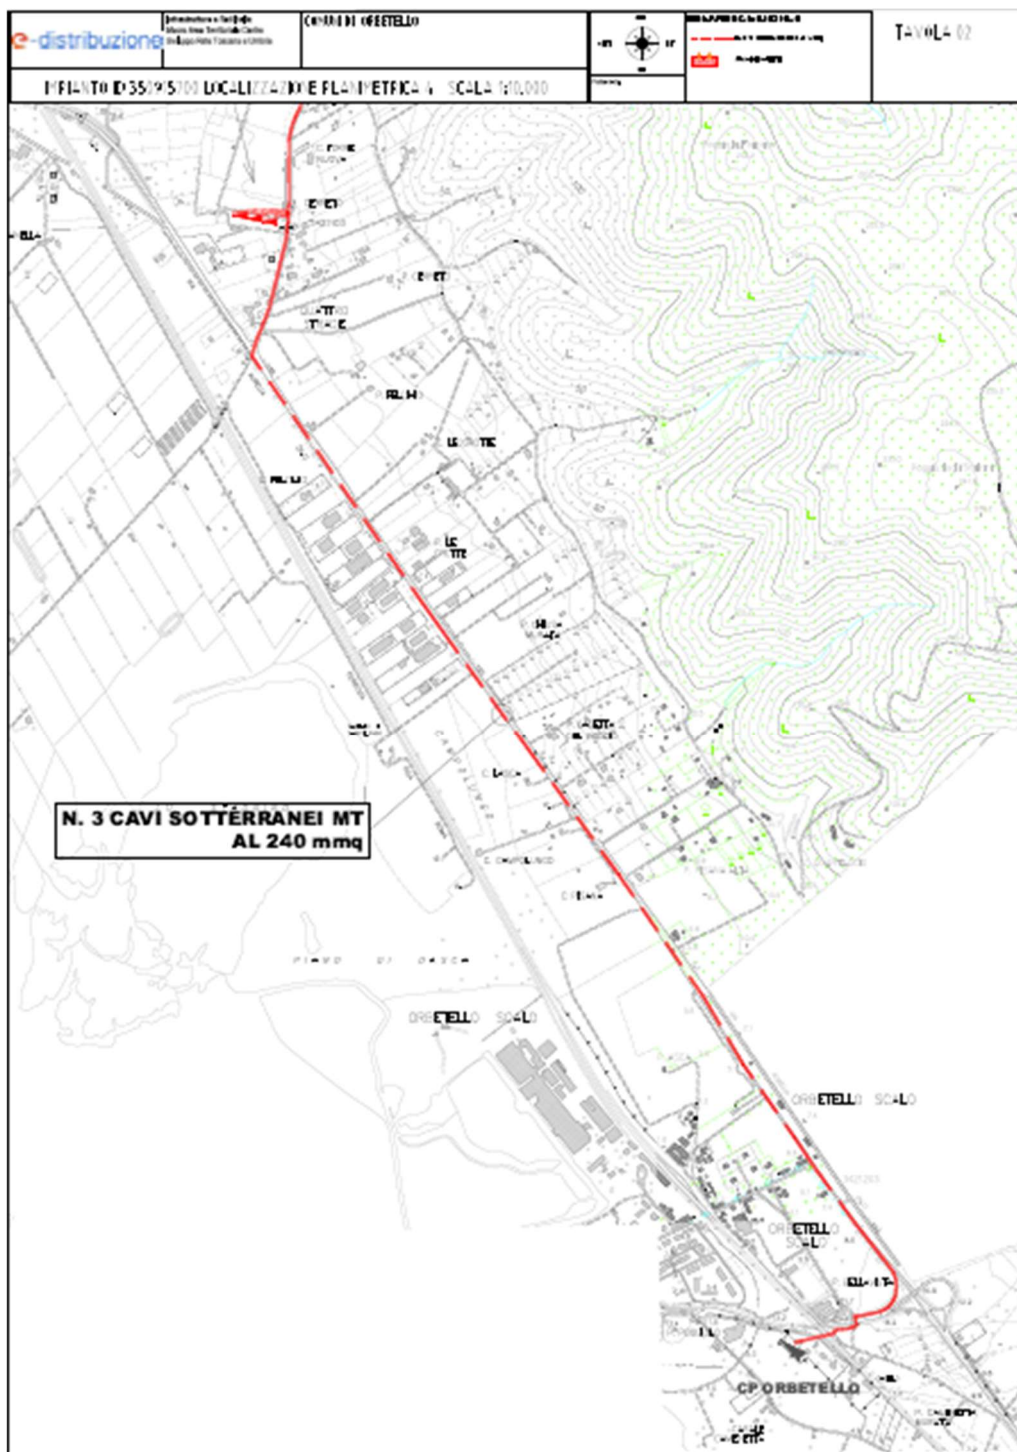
Impianto di rete per la connessione con cavo interrato TAVOLA 02
